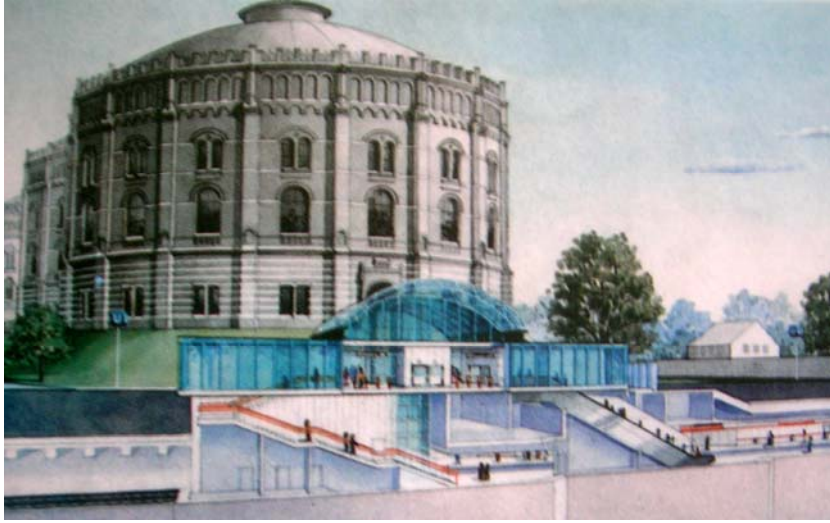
Viyana Gazhaneleri genel görünüş planı
